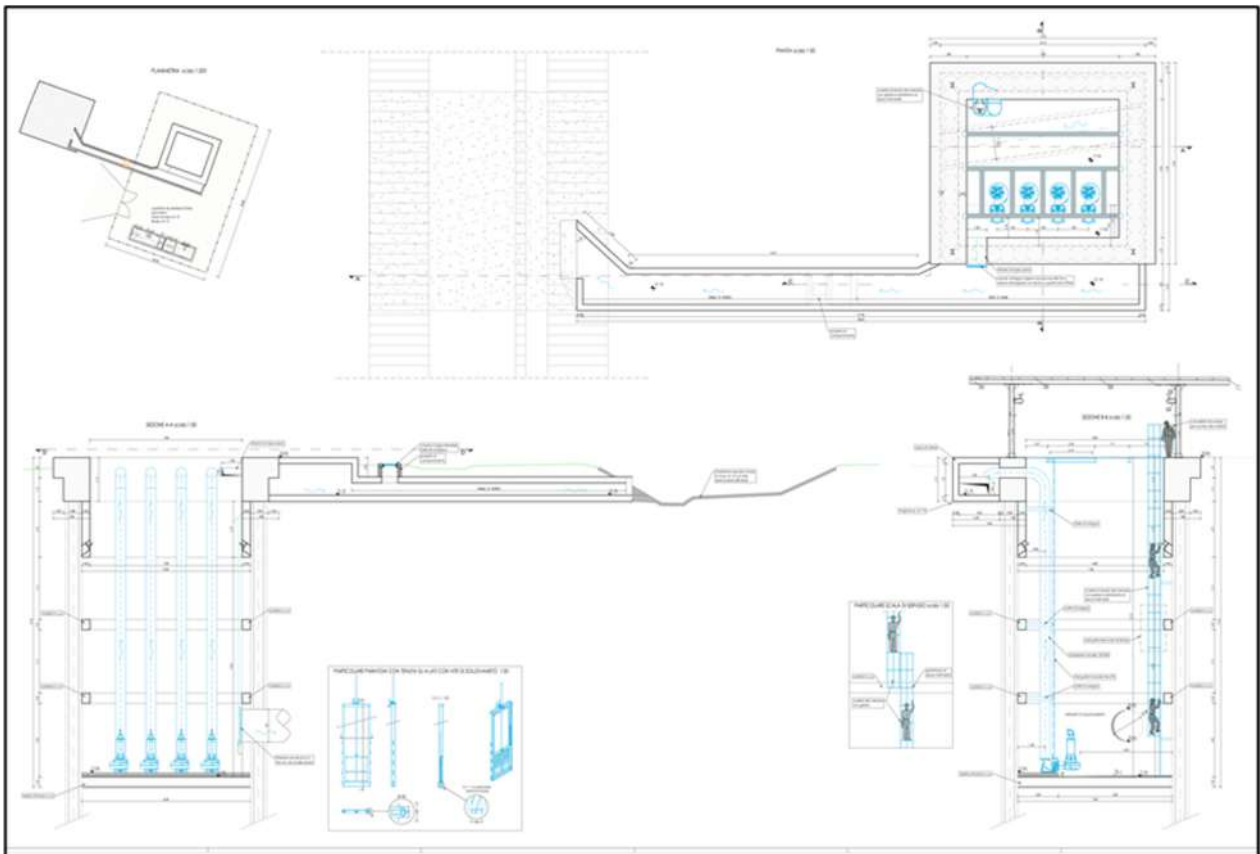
Planimetria Nuovo Impianto di Sollevamento e restituzione in Scol Fontana
